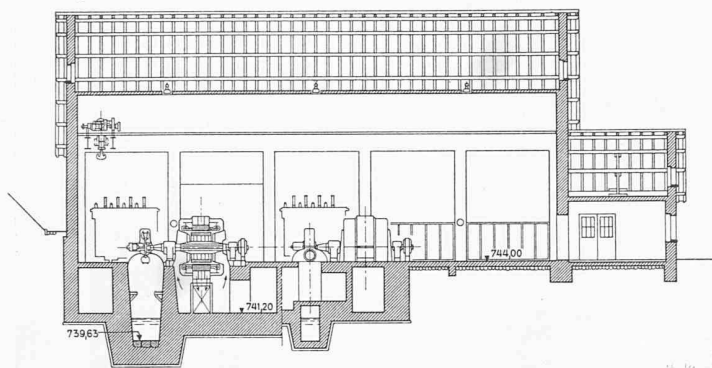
Längsschnitt durch das Maschinenhaus, 1:400
